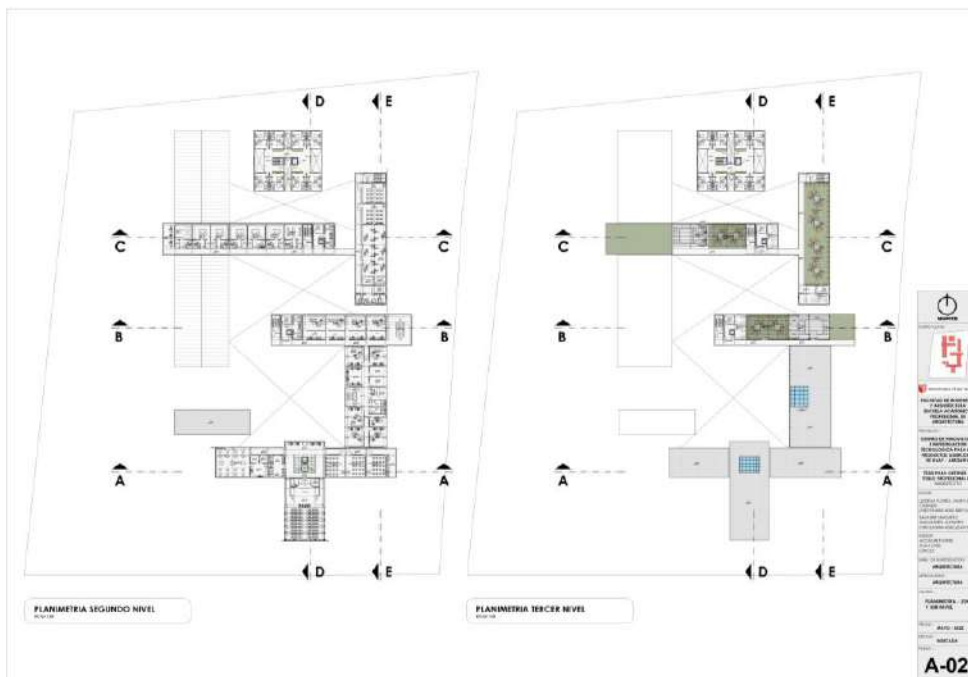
Plano Planimetría General – Segundo y Tercer Nivel.
